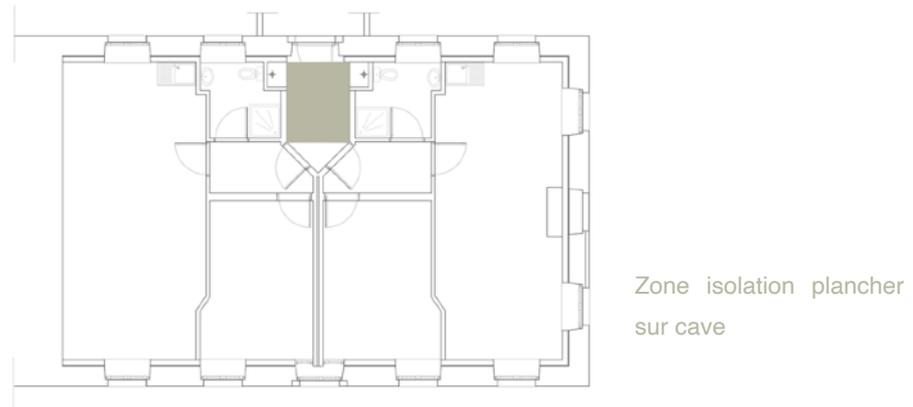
Isolation du plancher sur cave. Source : Sophie Rulkin.
